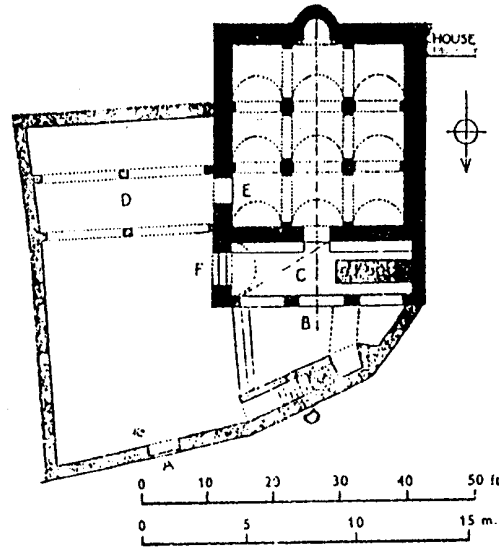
مسقط أفقي لمسجد خان الزبيب (عن : Creswell)
